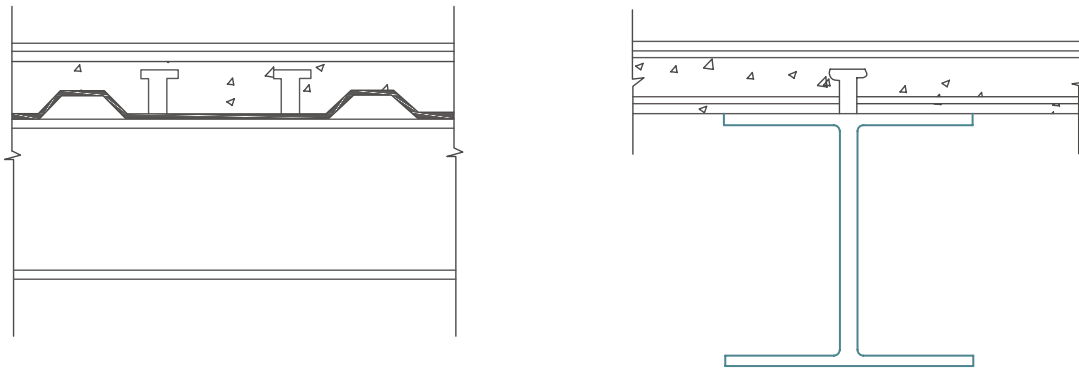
Vigas compuestas interconectadas para trabajo conjunto.
